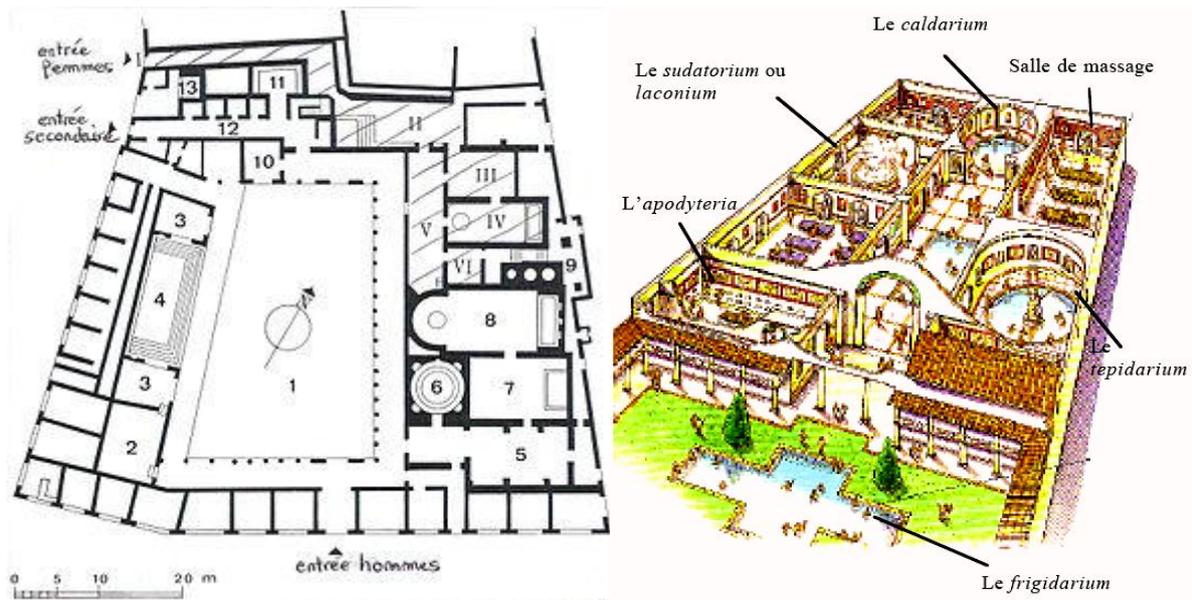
Plan des thermes de Stabies d'après Jean-Pierre Adam.
